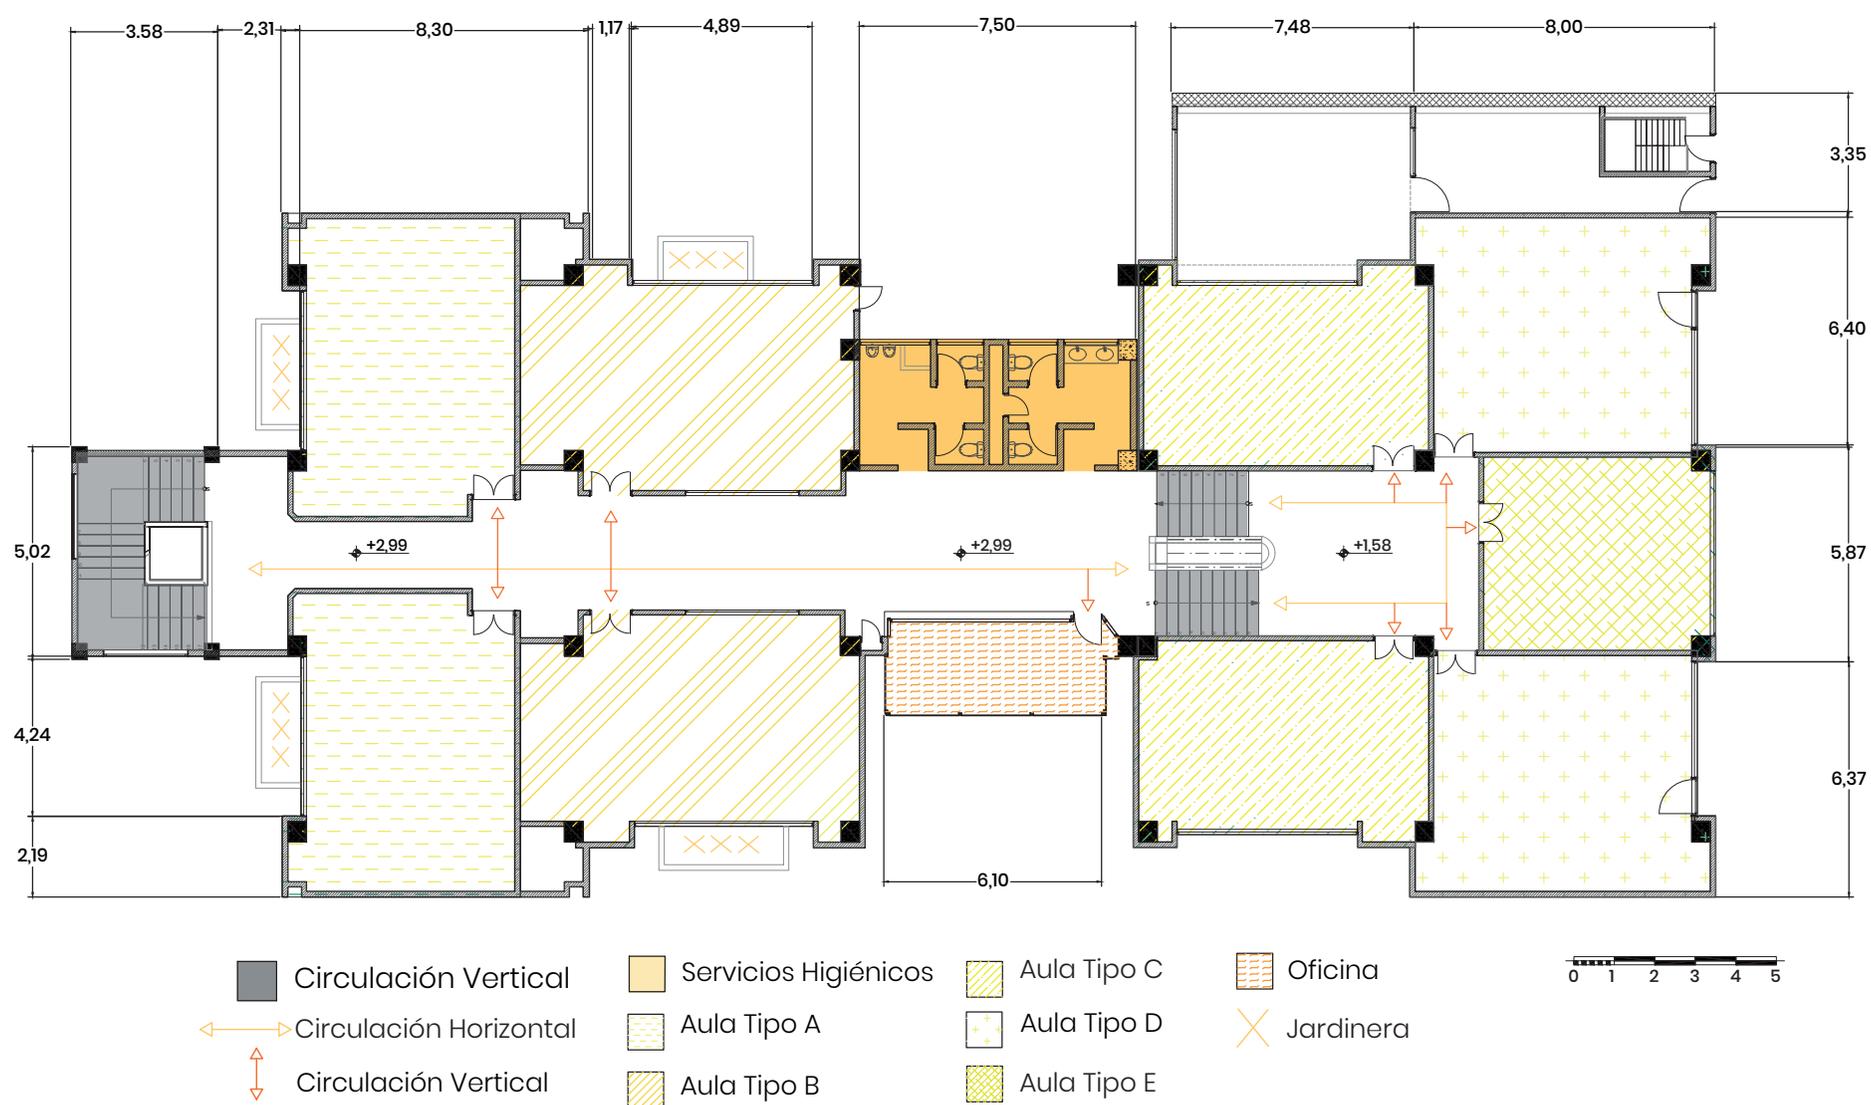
Zonificación Primera y Segunda Planta Alta Bloque "E1".
